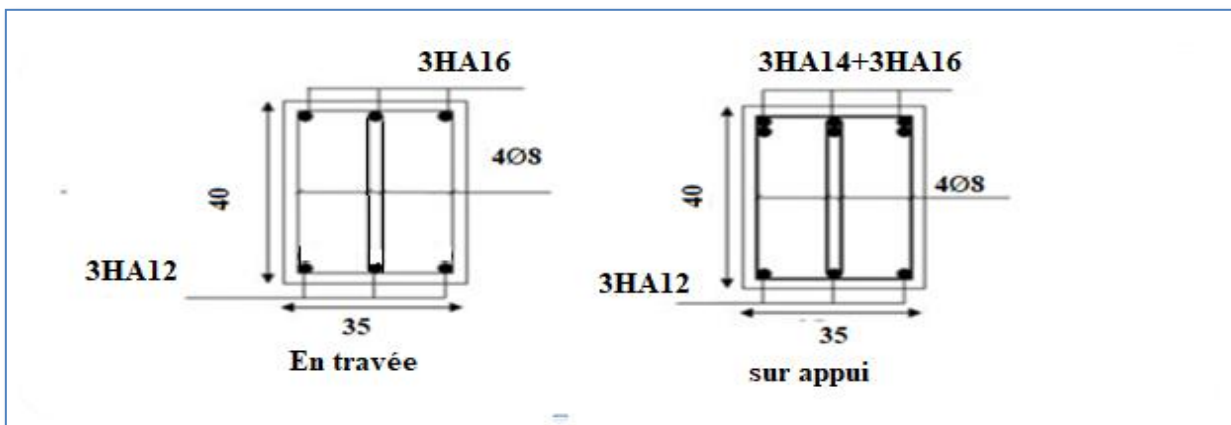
Ferraillage du Poutre principale (35x40)
